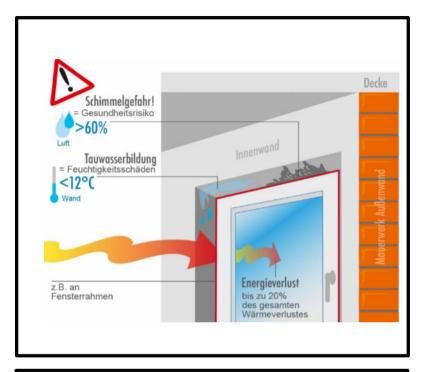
Fensterlaibung – außengedämmtes Mauerwerk
